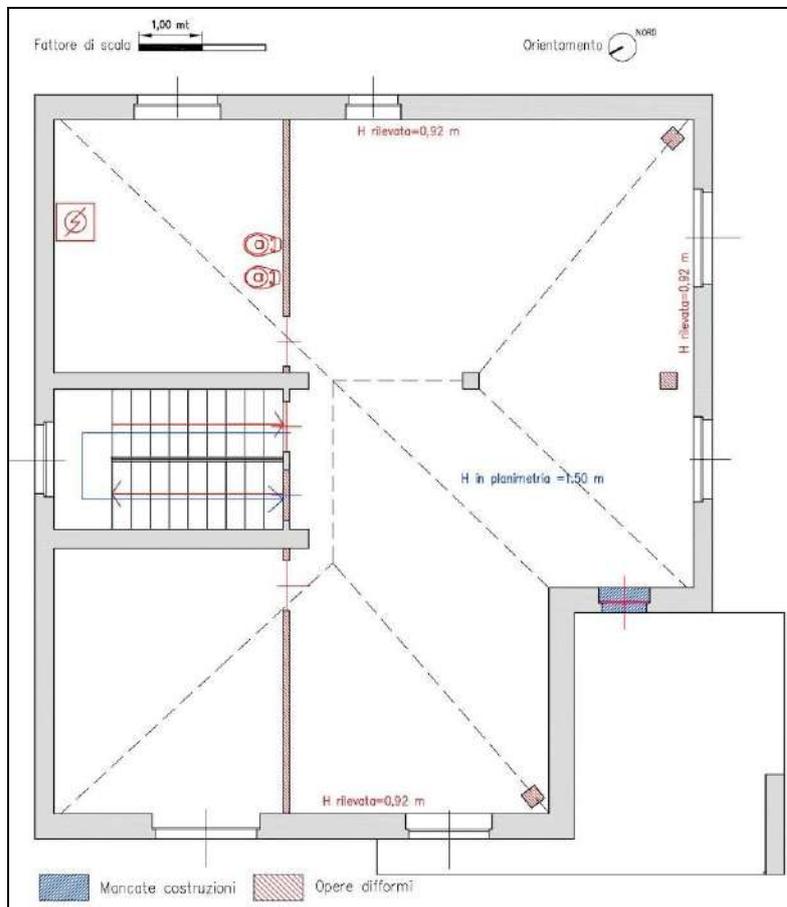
Pianta piano sottotetto - confronto con la planimetria catastale ultima in atti
